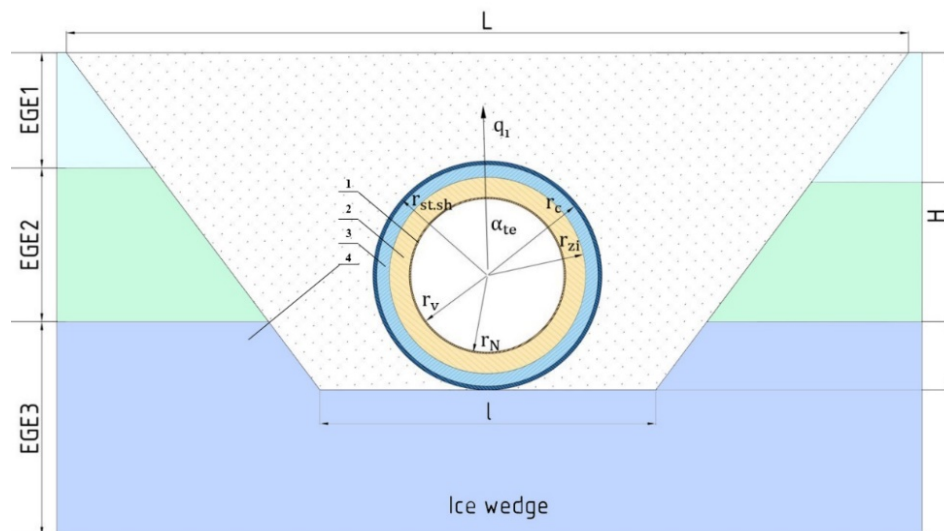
Расчетная модель теплового взаимодействия подземного нефтепровода в многолетнемерзлых грунтах: 1 — стальная труба; 2 — пенополиуретановая теплоизоляция; 3 — наномодифицированное бетонное покрытие; 4 — многолетнемерзлый грунт, представленный слоями инженерно-геологических элементов (ИГЭ)
